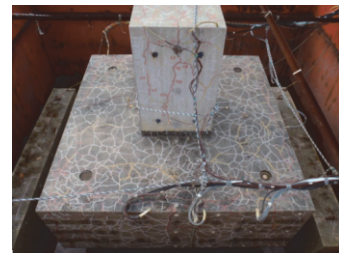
直接基礎タイプCase2のひび割れ状況
